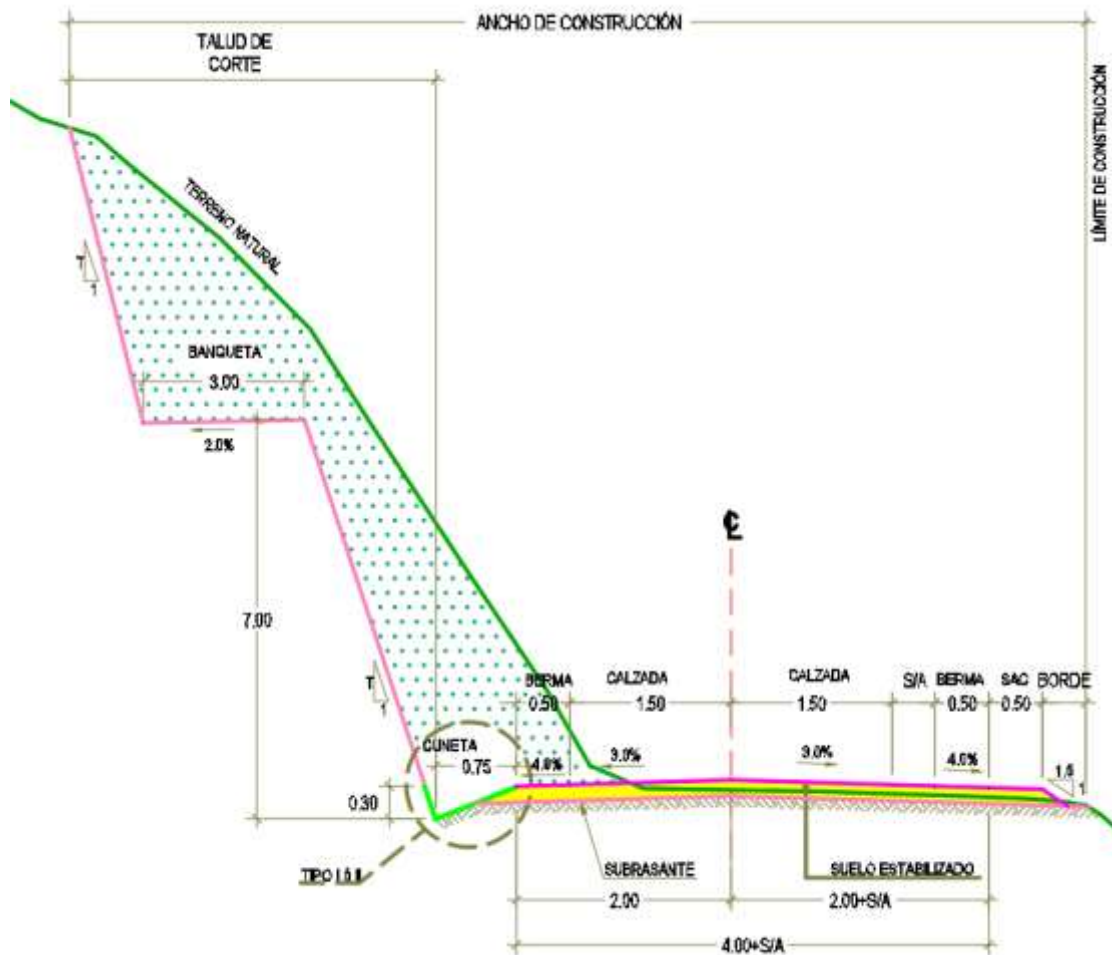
Sección típica con banqueta de corte. Fuente: plano de Secciones Típicas.
